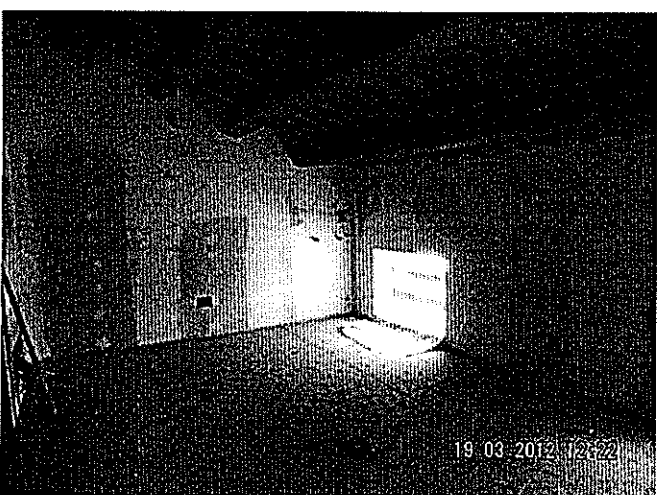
Stanza 2.6: Vista parete esterna con tetto e finestra
